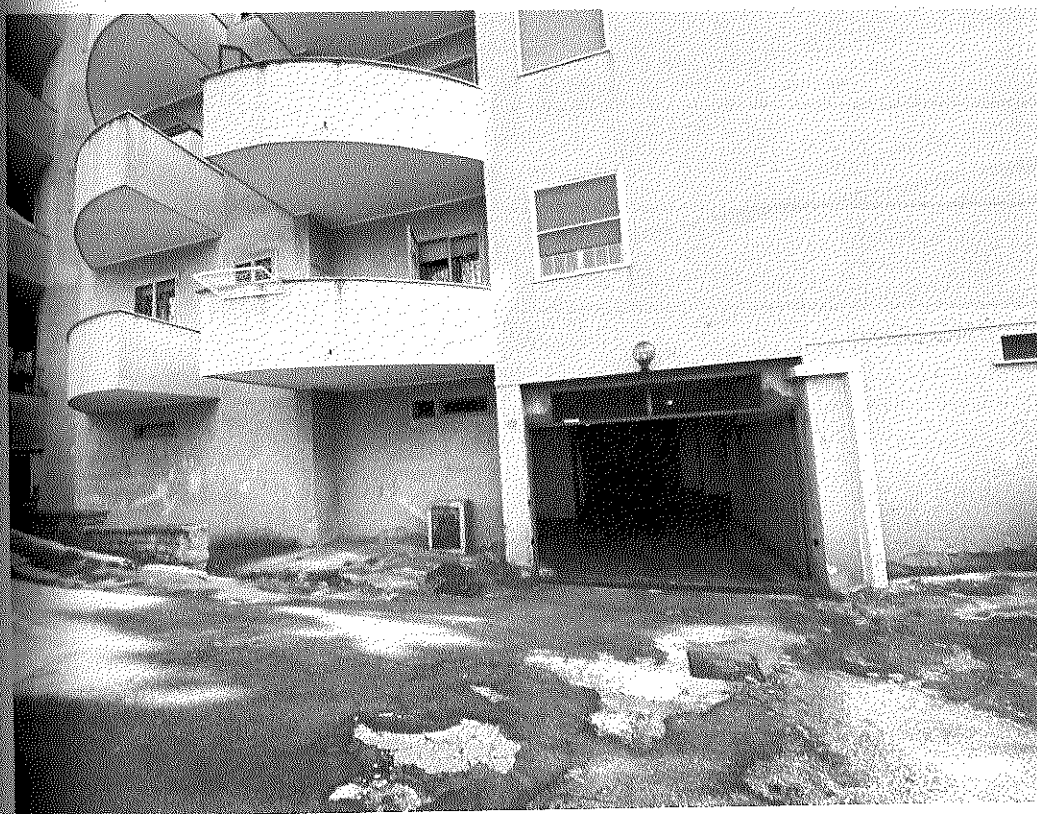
Vista dell'area interna all'edificio con accesso dal civico 9 e la porta di accesso ai box.
